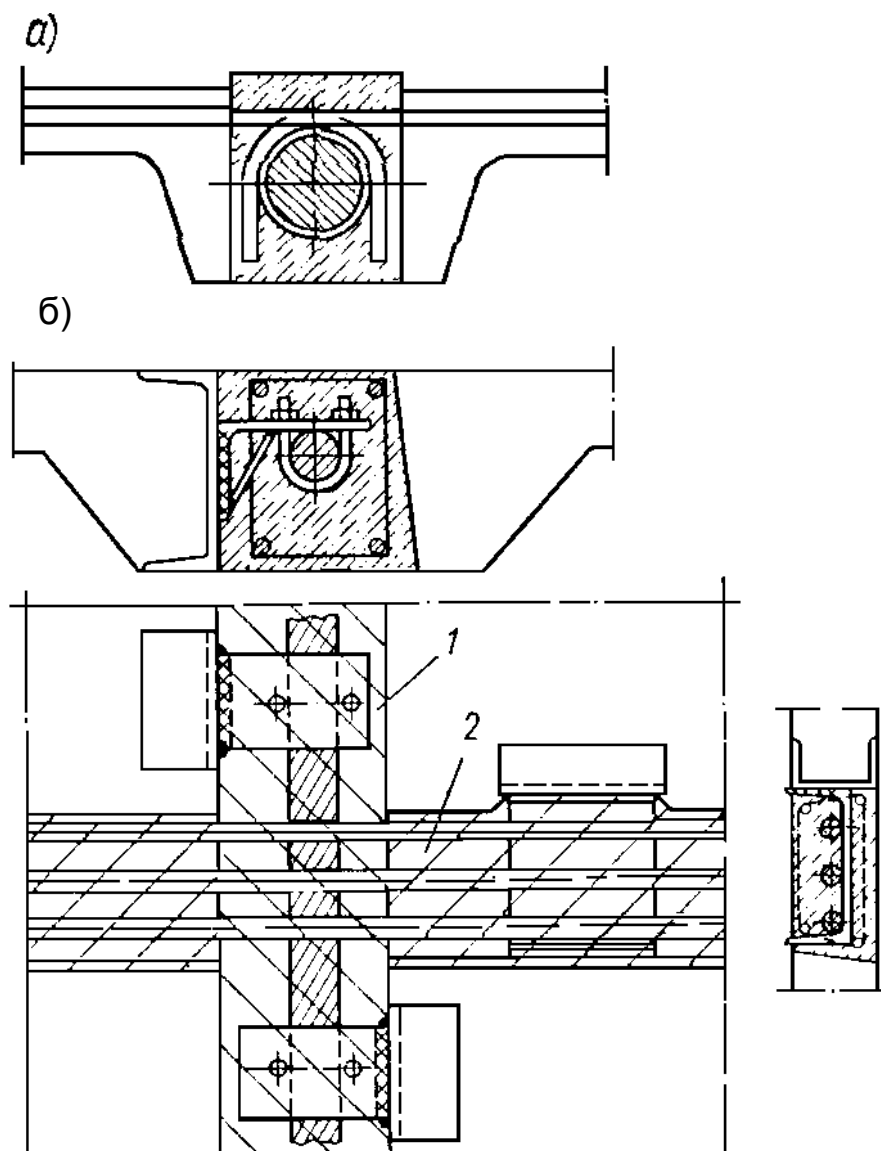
Сопряжение железобетонных плит с арматурой при напряжении пригрузом (а) и домкратами (б):
